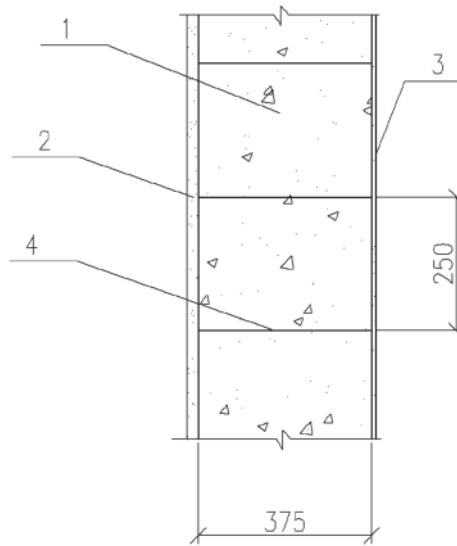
Схема однородной кладки стен из газобетона с наружным штукатурным покрытием:
